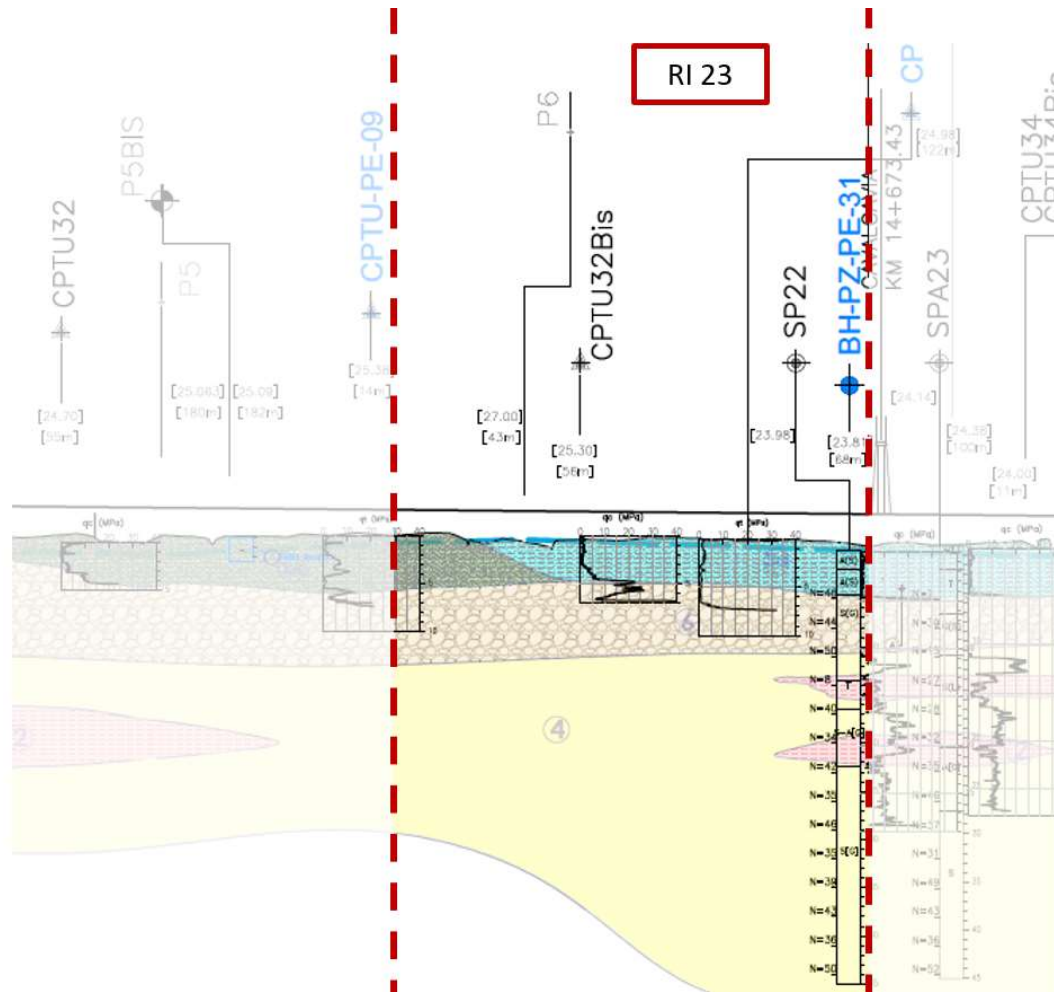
Profilo Geotecnico Rilevato RI23, estratto dal Profilo Geotecnico Generale (Doc. Rif. [3])
